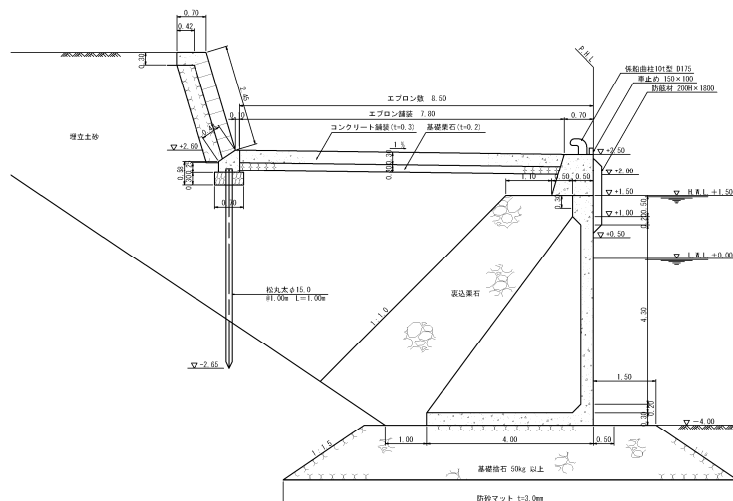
No.4 中央船溜物揚場 (L型ブロック区間) の標準断面図 (被災前)
